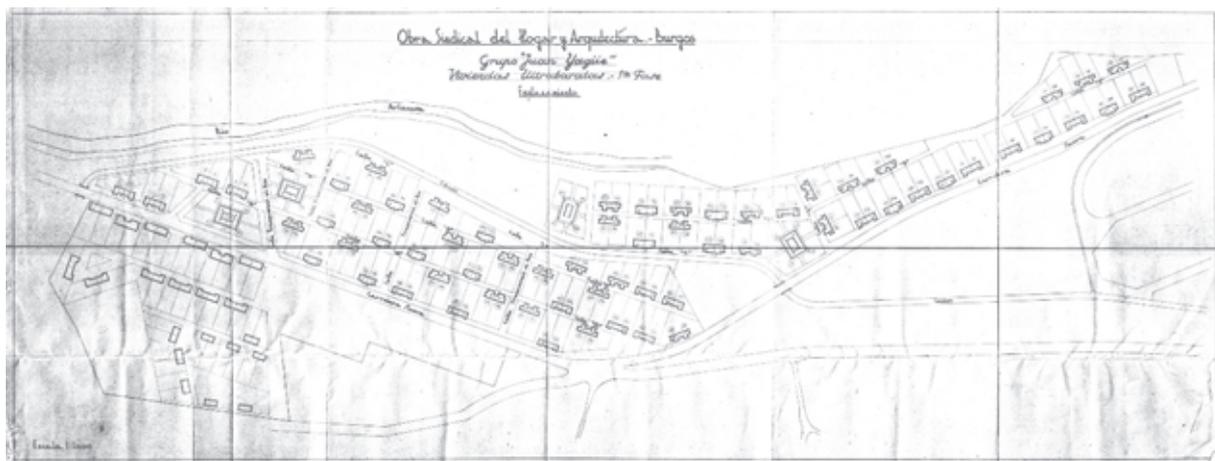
Plano de emplazamiento del proyecto de la primera fase del grupo «Juan Yagüe» de viviendas ultrabaratas, Burgos, 1945. Fuente: ACFomJCyL, exp. 1088. Nota 1: obsérvese que el plano no está norteado, más bien al contrario, con el río Arlanzón por encima (al sur) de la barriada. Nota 2: la realidad construida no siguió fielmente este plano general, pues las viviendas proyectadas entre el río y la carretera del Penal sumaban solo 148 de las 152 previstas
